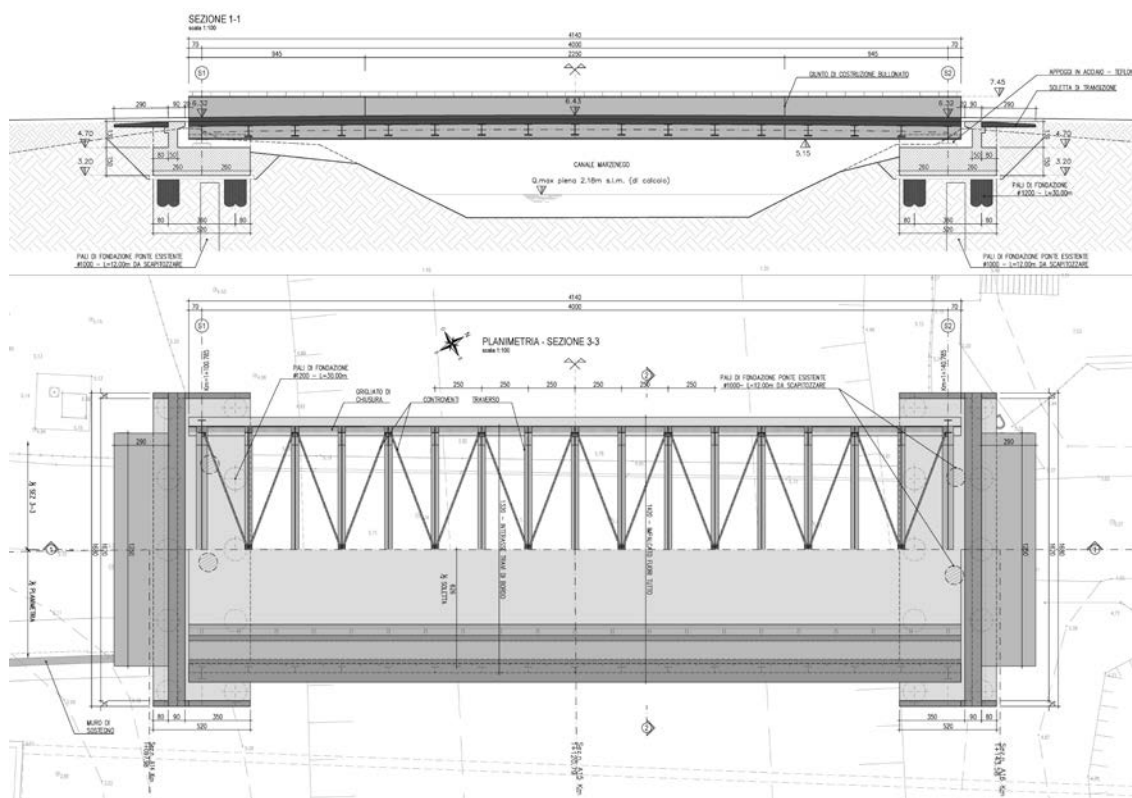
Ponte sul canale Marzenego – Pianta e Sezione longitudinale
